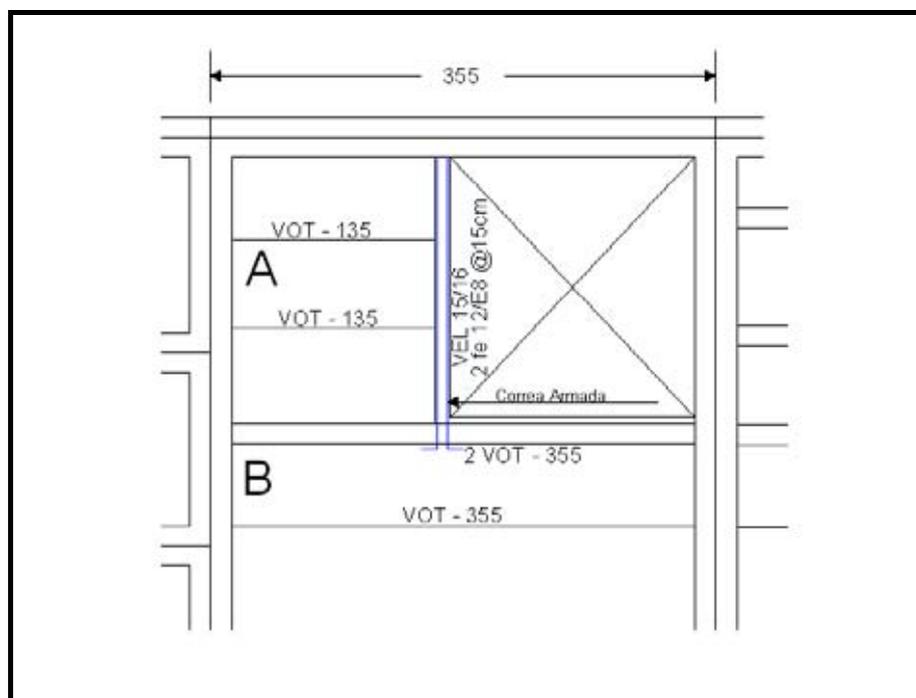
Vista en planta correas para losas con discontinuidades de luz.
